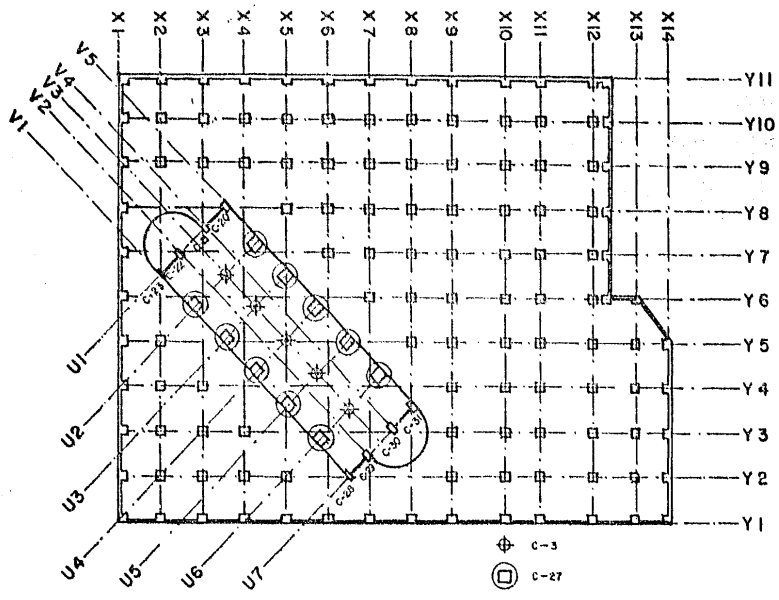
LOCALIZACION DE COLUMNAS EN ZONA DE TORRE
